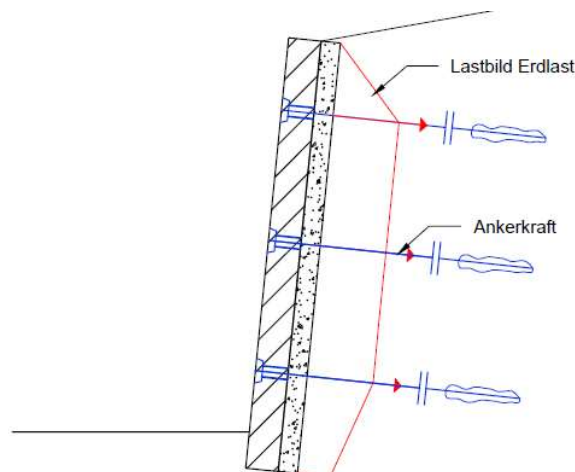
schematisches Lastbild bei vollflächiger Ortbetonwand
